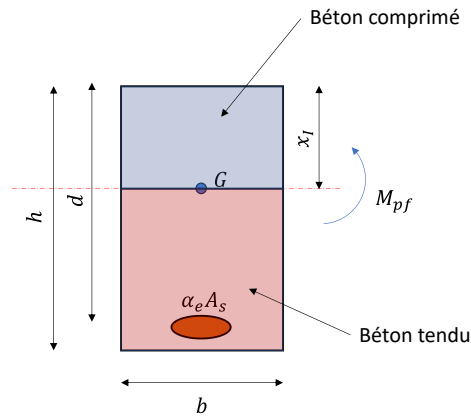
Section élastique non fissurée – béton sans fibre
